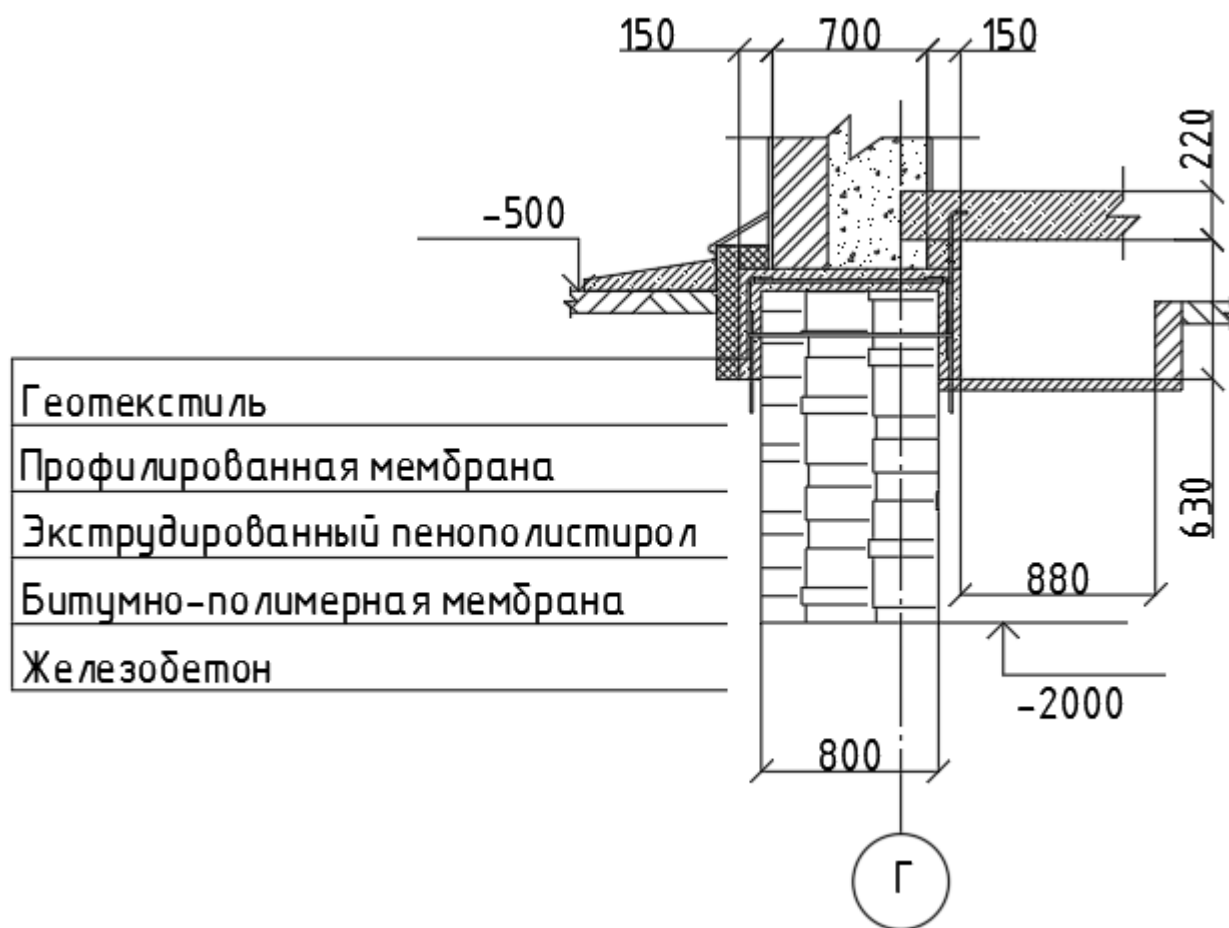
Бетонная рубашка в верхнем поясе
